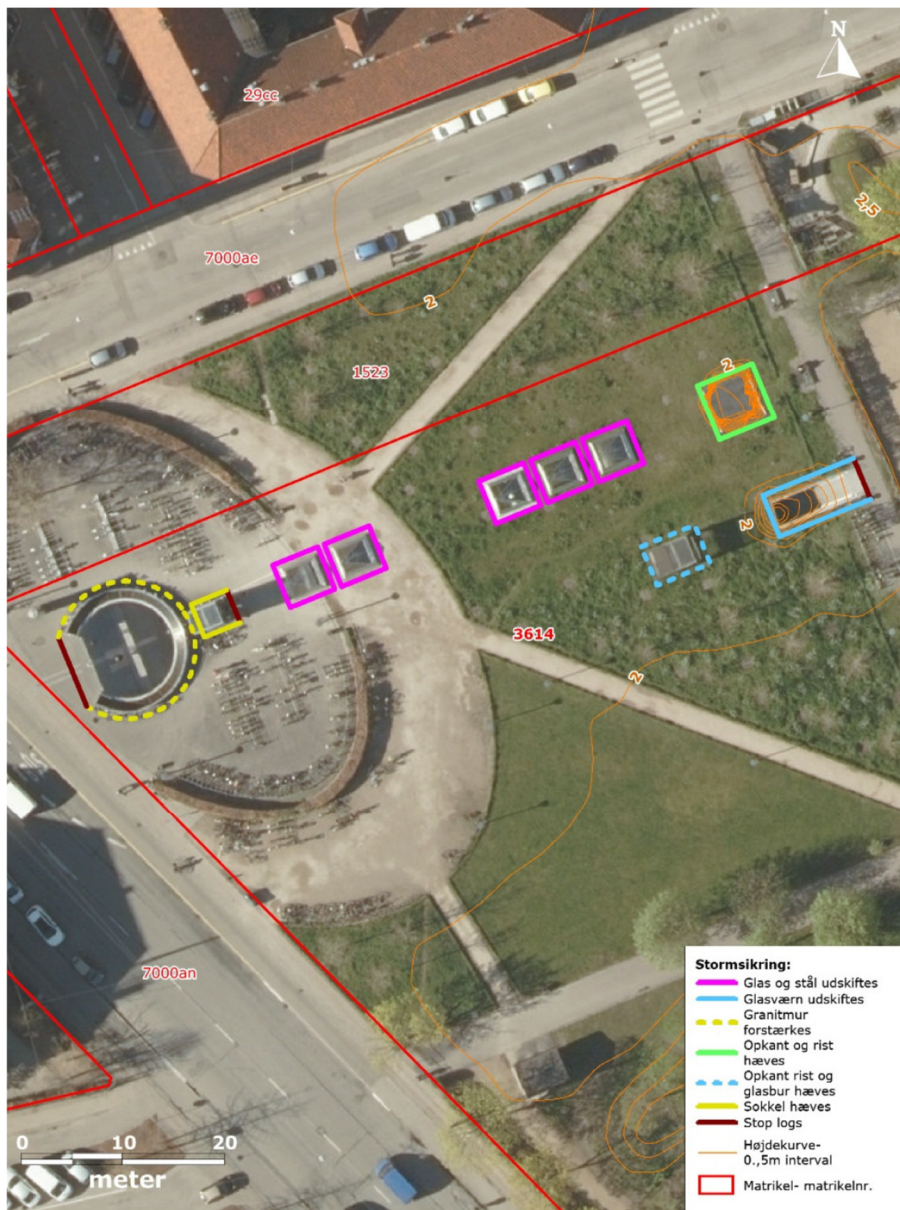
Oversigtsplan over Lergravsparken Station med matrikler
